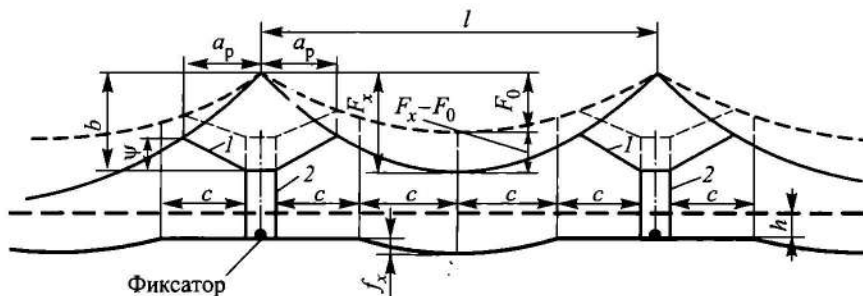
Схема одинарной цепной подвески с рессорными тросами:
